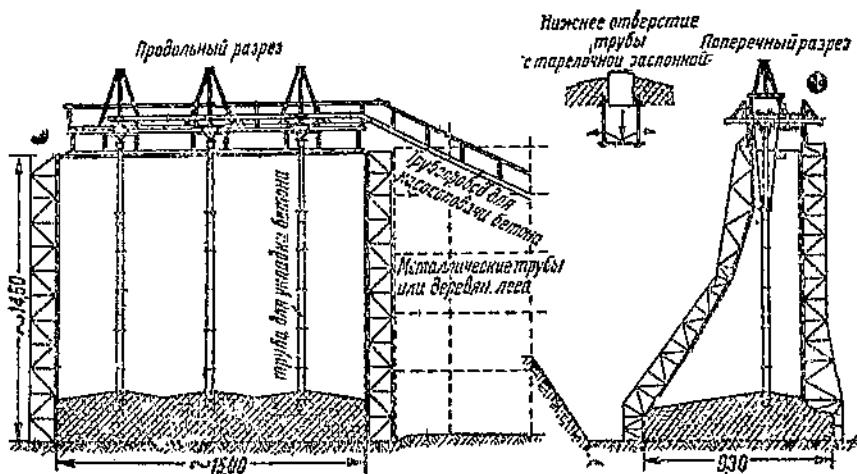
Схема бетонирования стенок шлюза с помощью вертикально перемещающихся труб при подаче бетона насосами.
